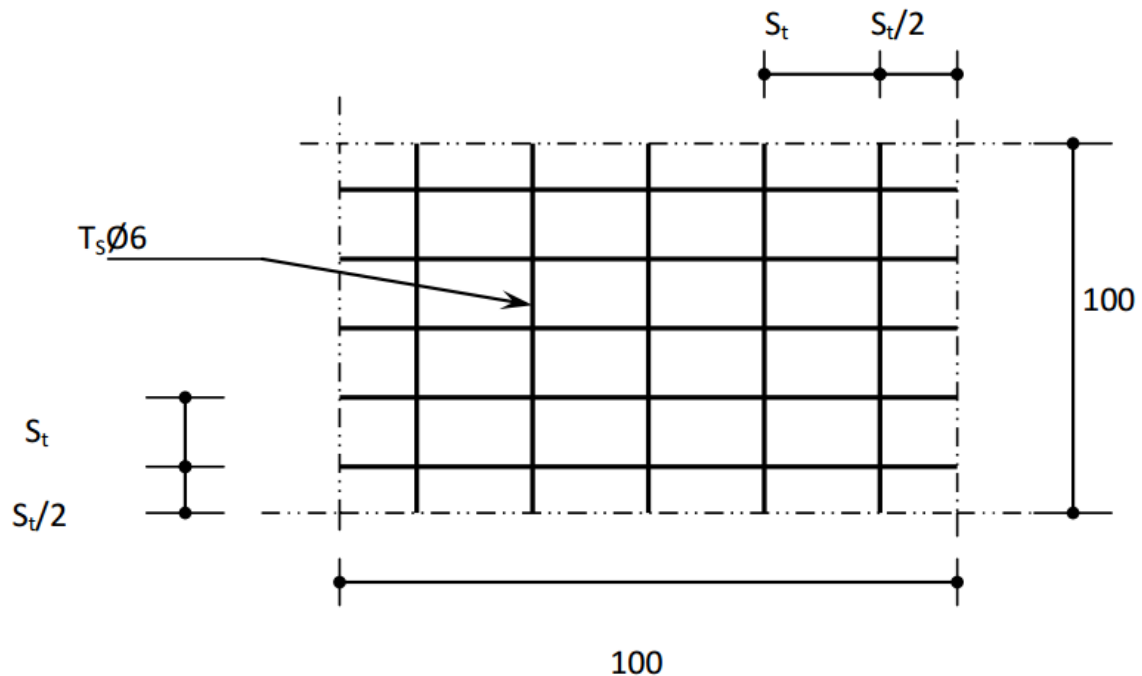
Disposition constructive des armatures de la dalle de compression.
